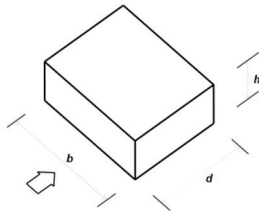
Parametri caratteristici di edifici a pianta rettangolare.
